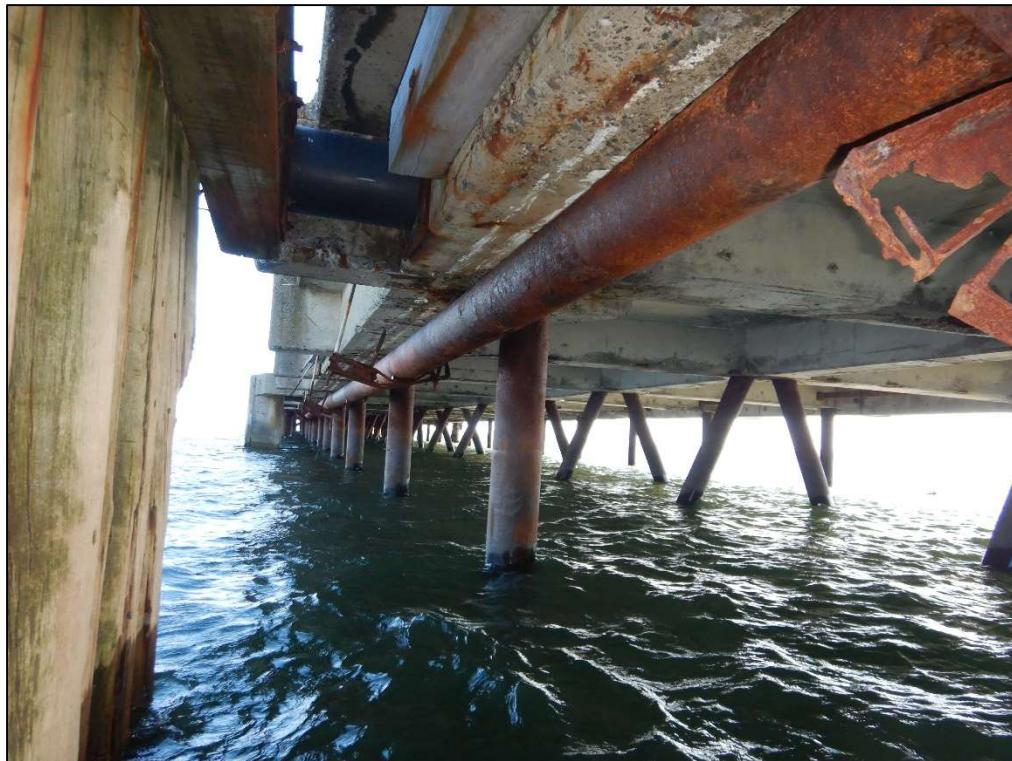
TRAVÉE N°45 (EST) – TUYAU DONT LES ANCRAGES SONT SECTIONNÉS PAR LA CORROSION
